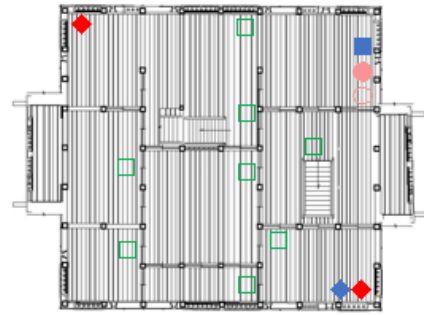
天守1階平面図及び東廊下・南廊下2階平面図（復元原案）
